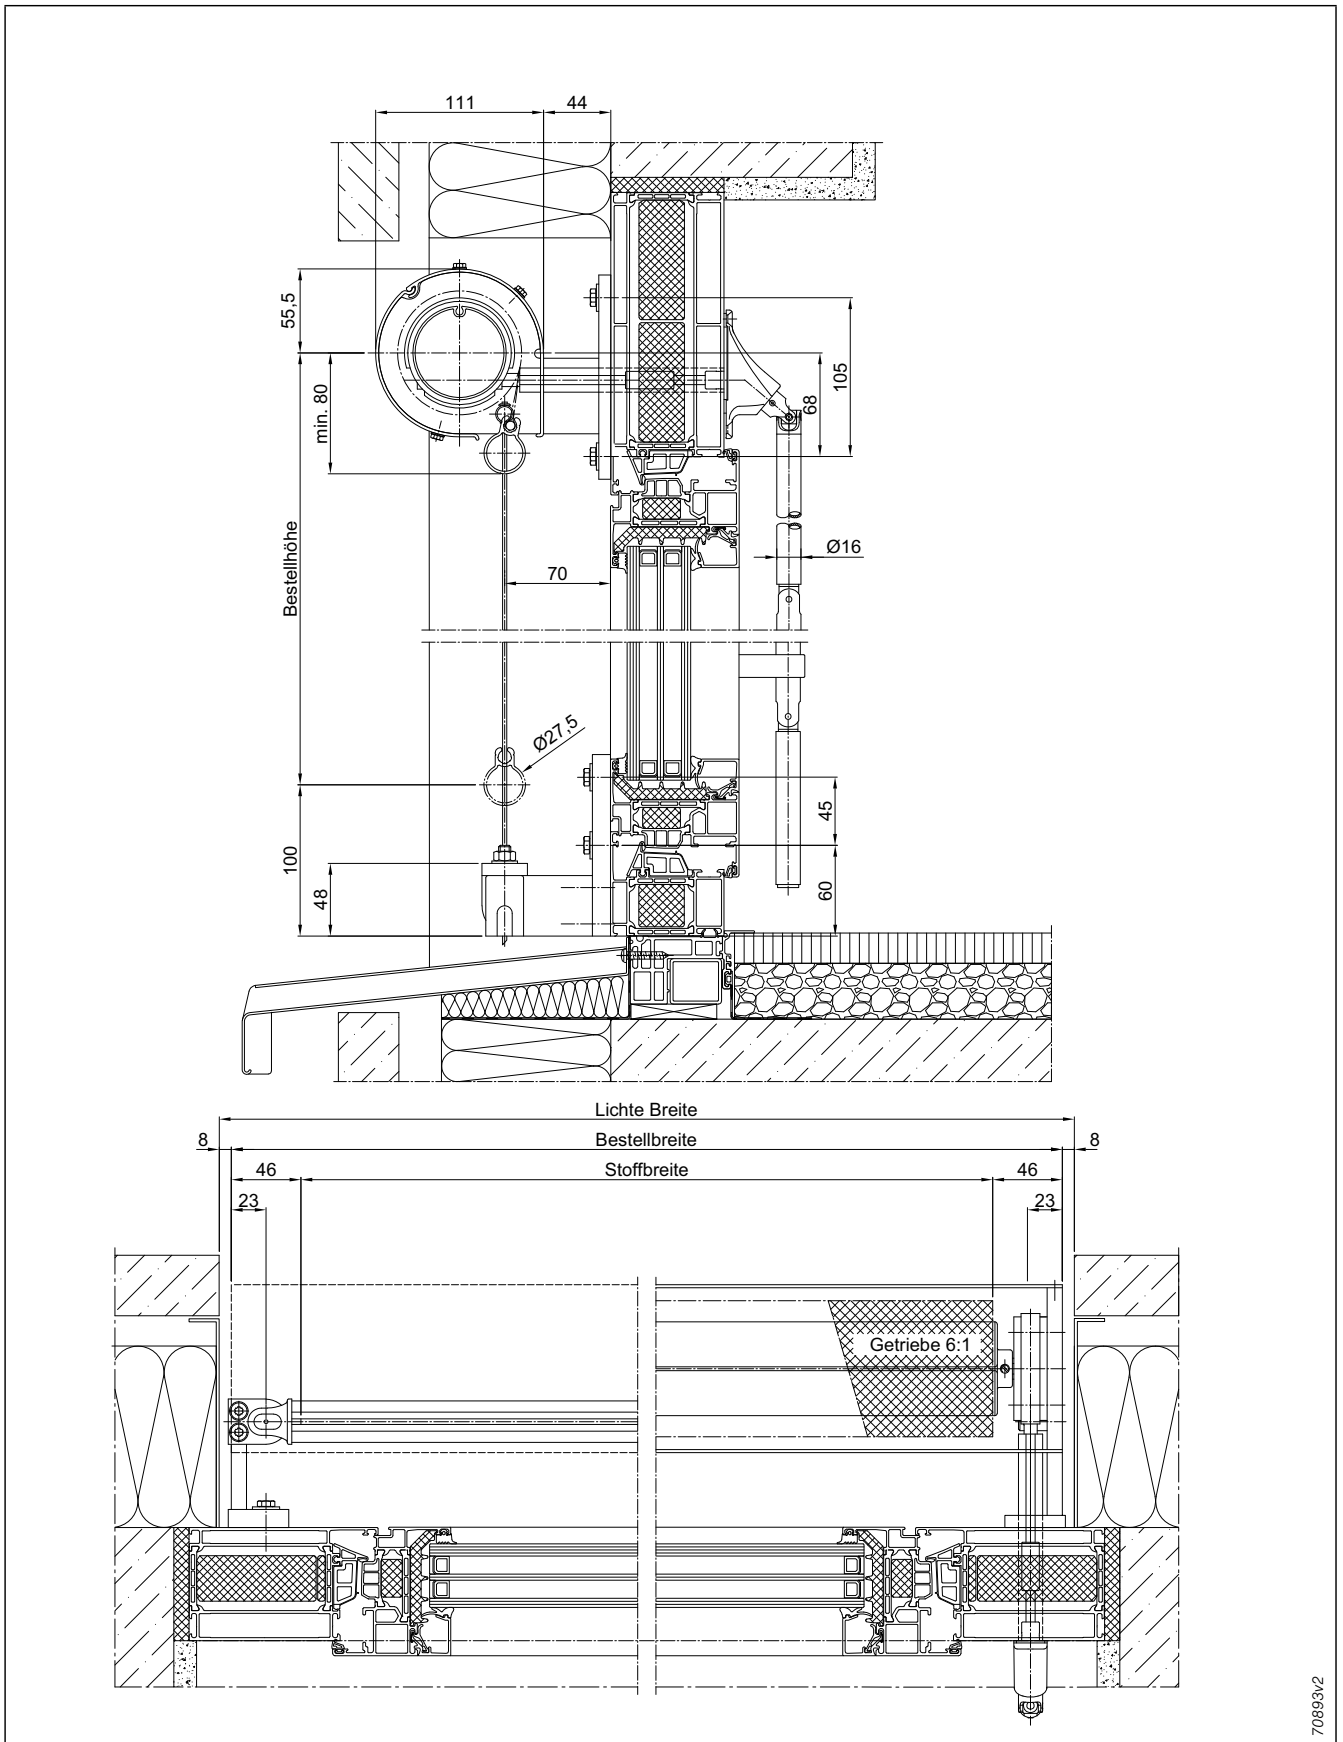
Fassaden-Markise 209 mit Rundblende Typ 23.3 und Spannseil
